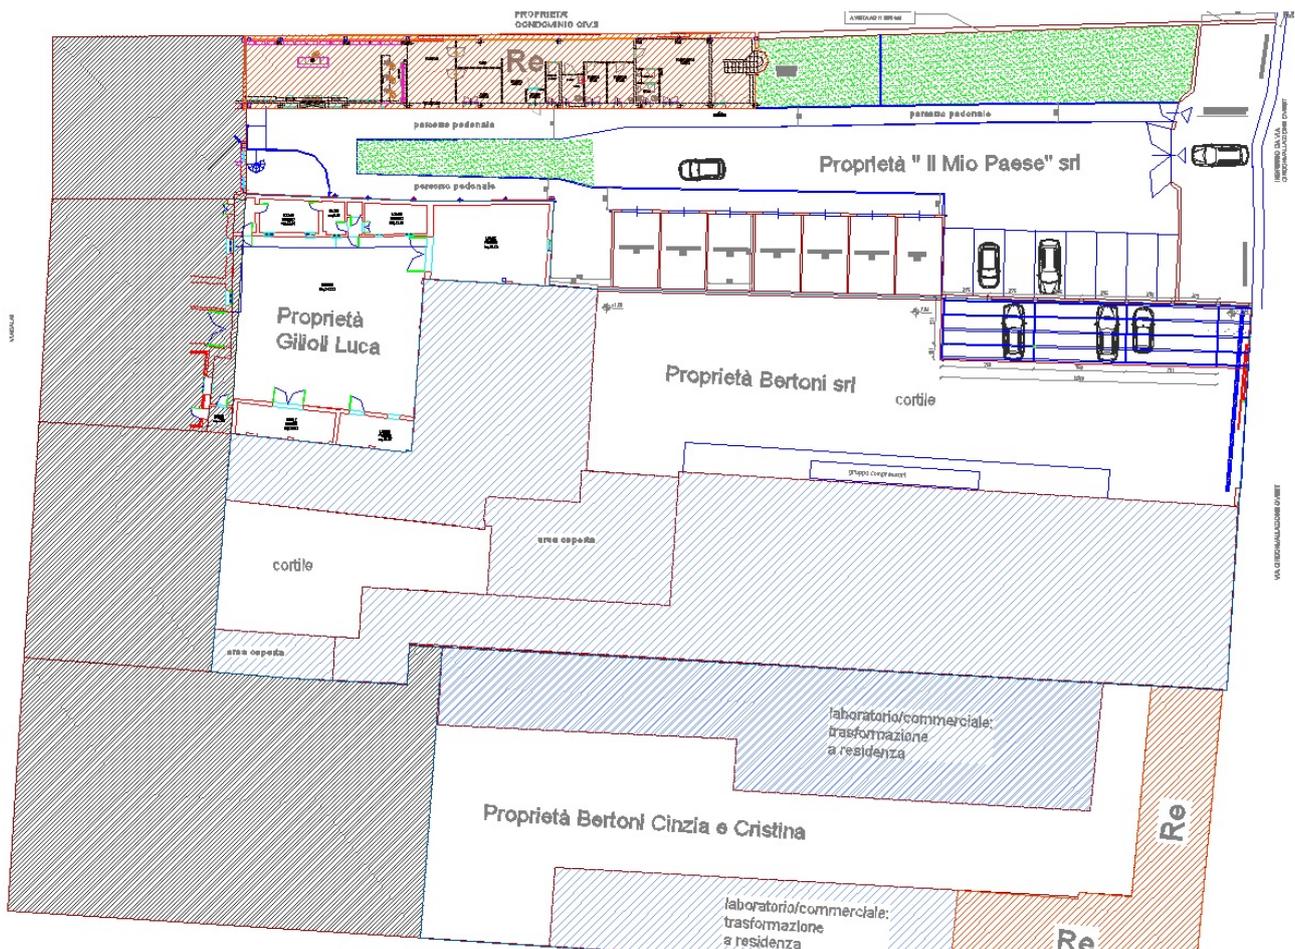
Vista planimetrica d'insieme del comparto PR6
